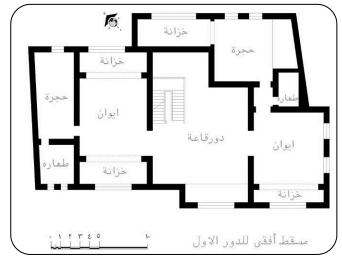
مسقط أفقى تصوري للدور الأول لخان داود باشا في ضوء وصف وثيقة الوقف (عمل الباحث)
